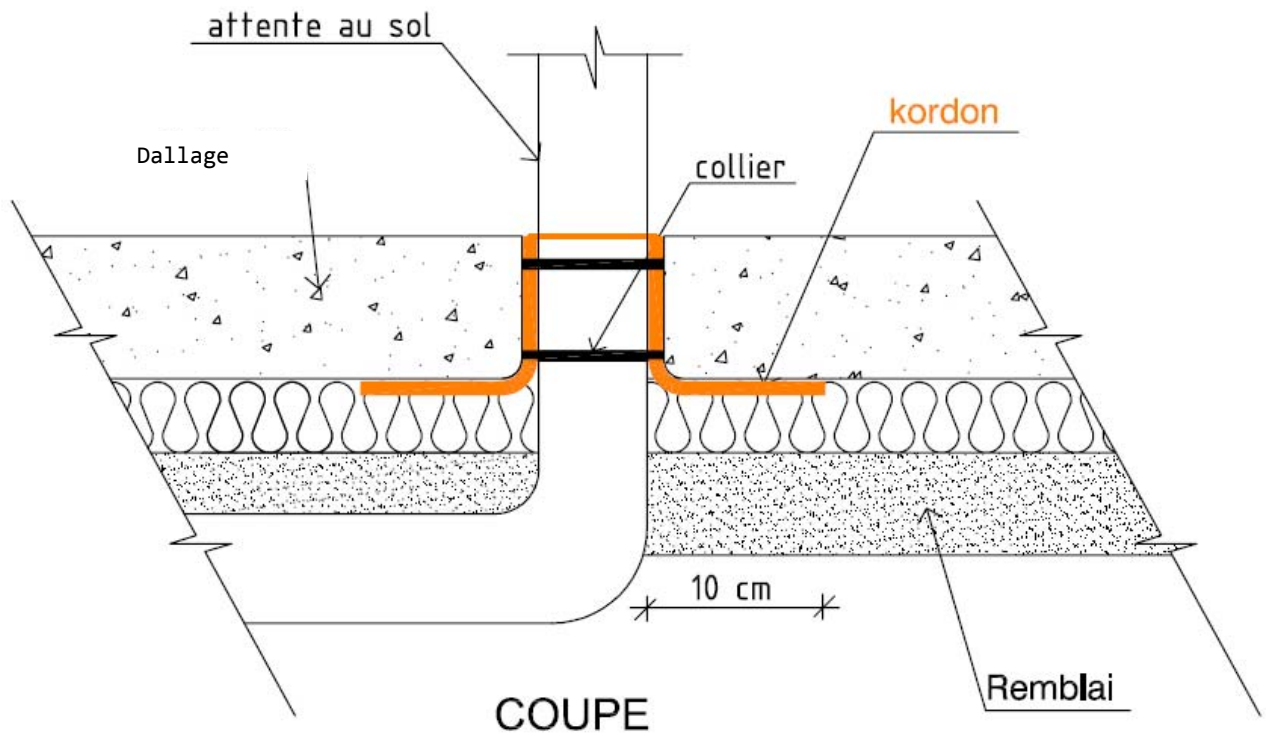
Traversées de dallage. Isolant sous dallage résistant aux termites.
